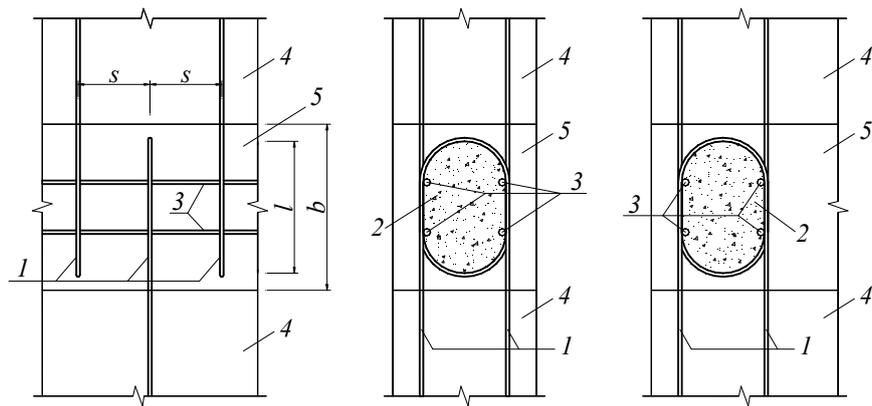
U 形钢筋交错布置现浇混凝土接缝
